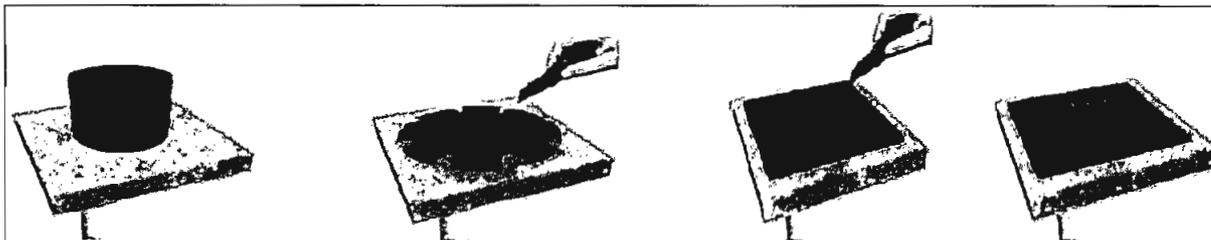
Imagens esquemáticas de aplicação de manta asfáltica em ralo.
